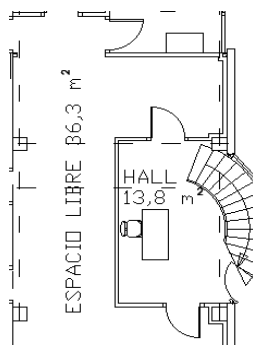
Zona de espacio libre. Fuente: Proyectista
